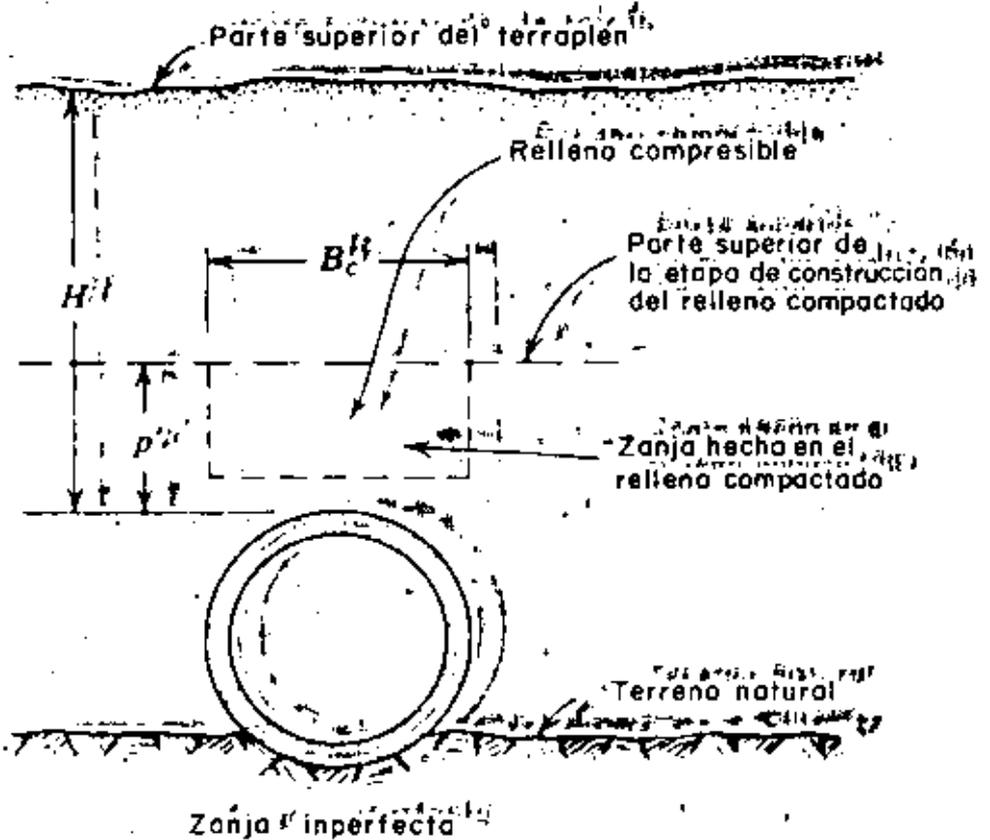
ILUSTRACION DE CONDUCTOS CON ZANJA
